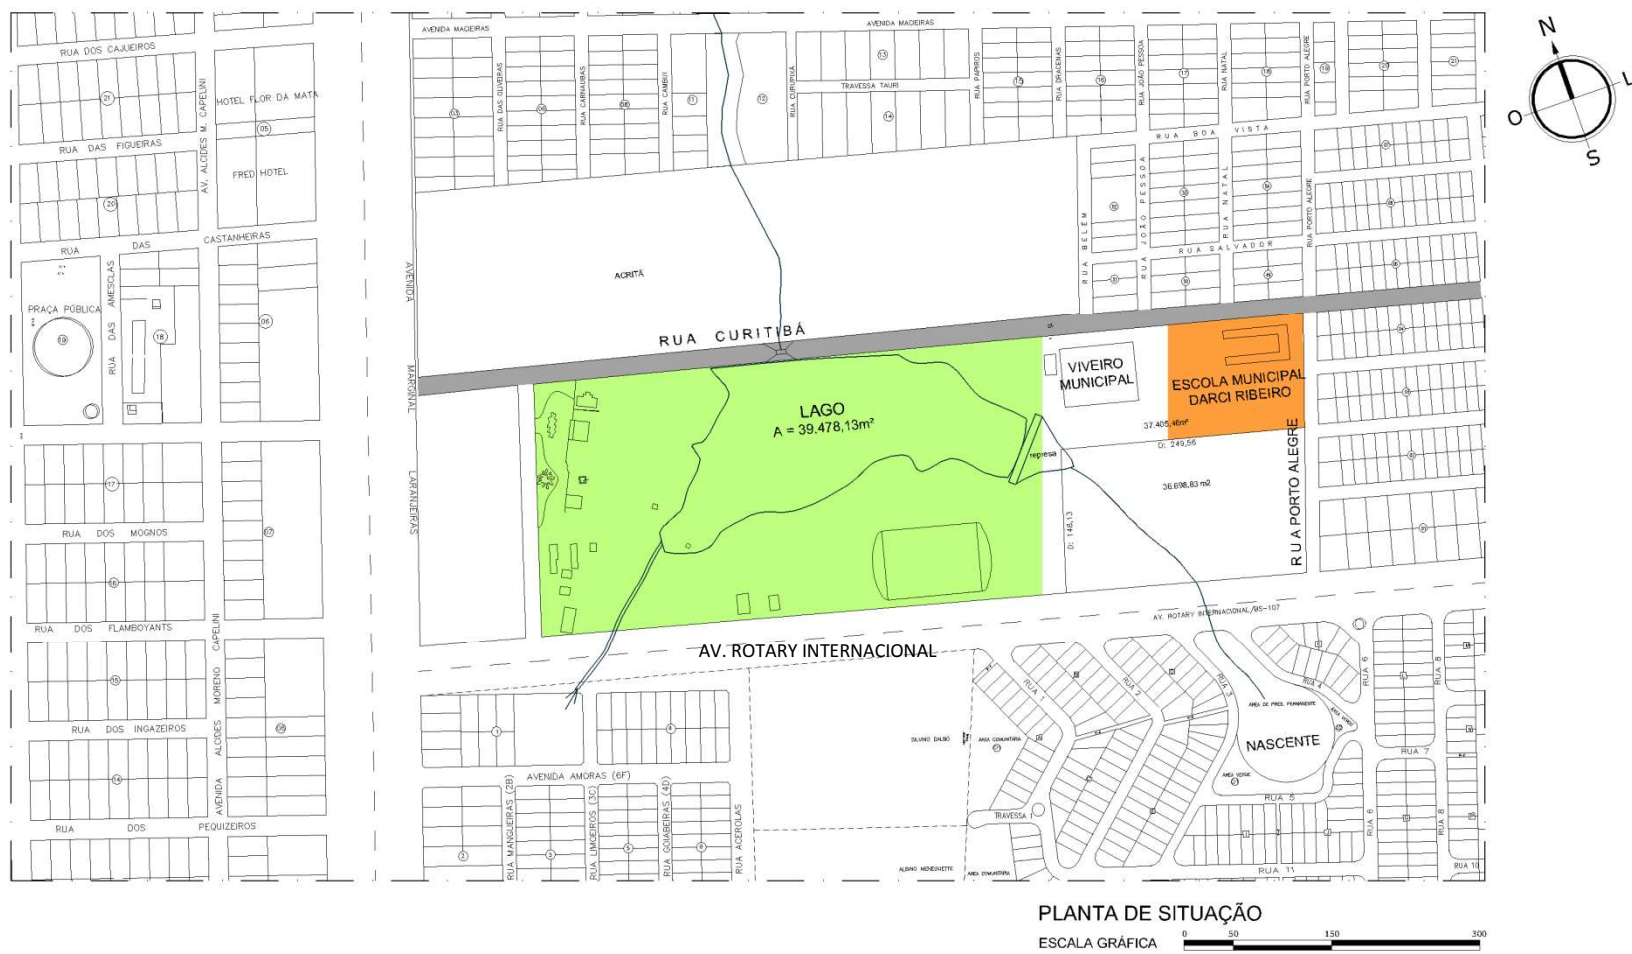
Planta de situação dos objetos de estudo em Guarantã do Norte
